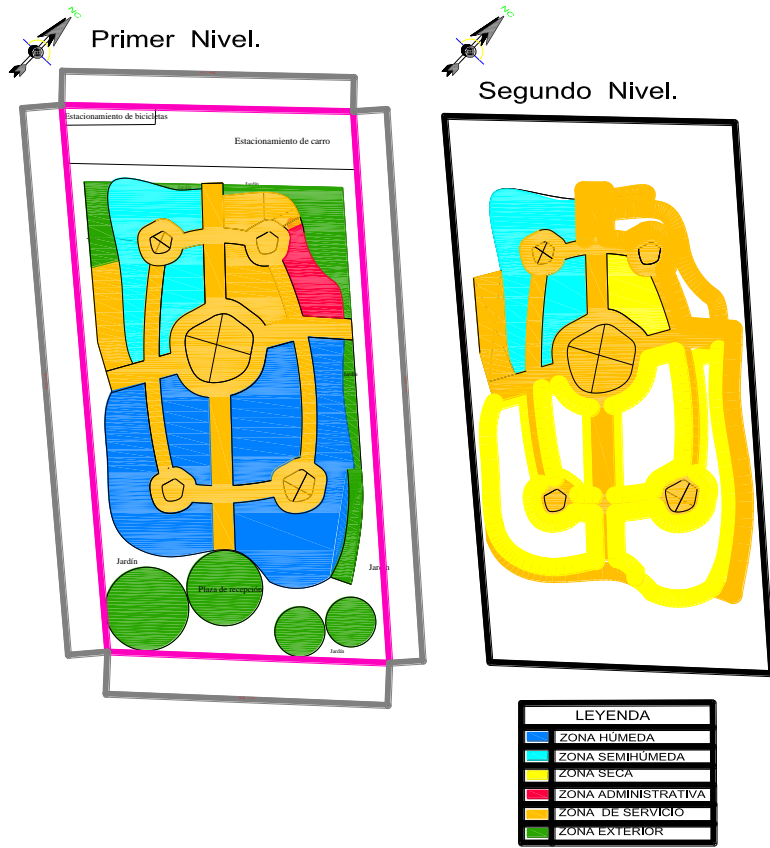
Partido arquitectónico por niveles Fuente Elaboración propia.
